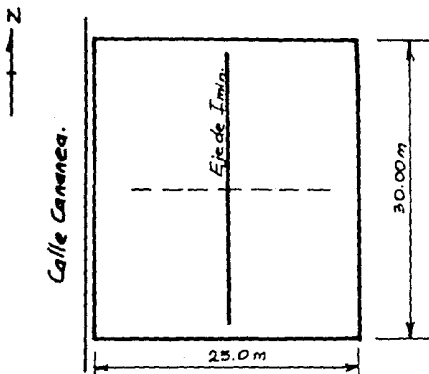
b Planta del edificio Cananea 7. Esc. 1:500.
